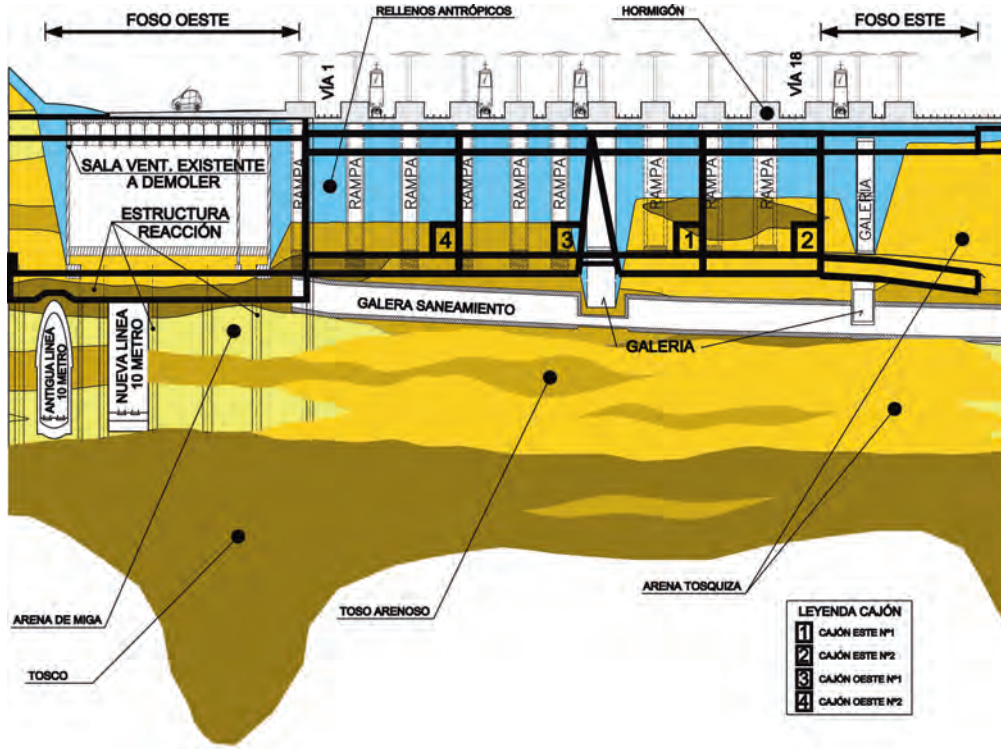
Perfil longitudinal geotécnico bajo vías FFCC / Longitudinal geotechnical profile under the tracks.
